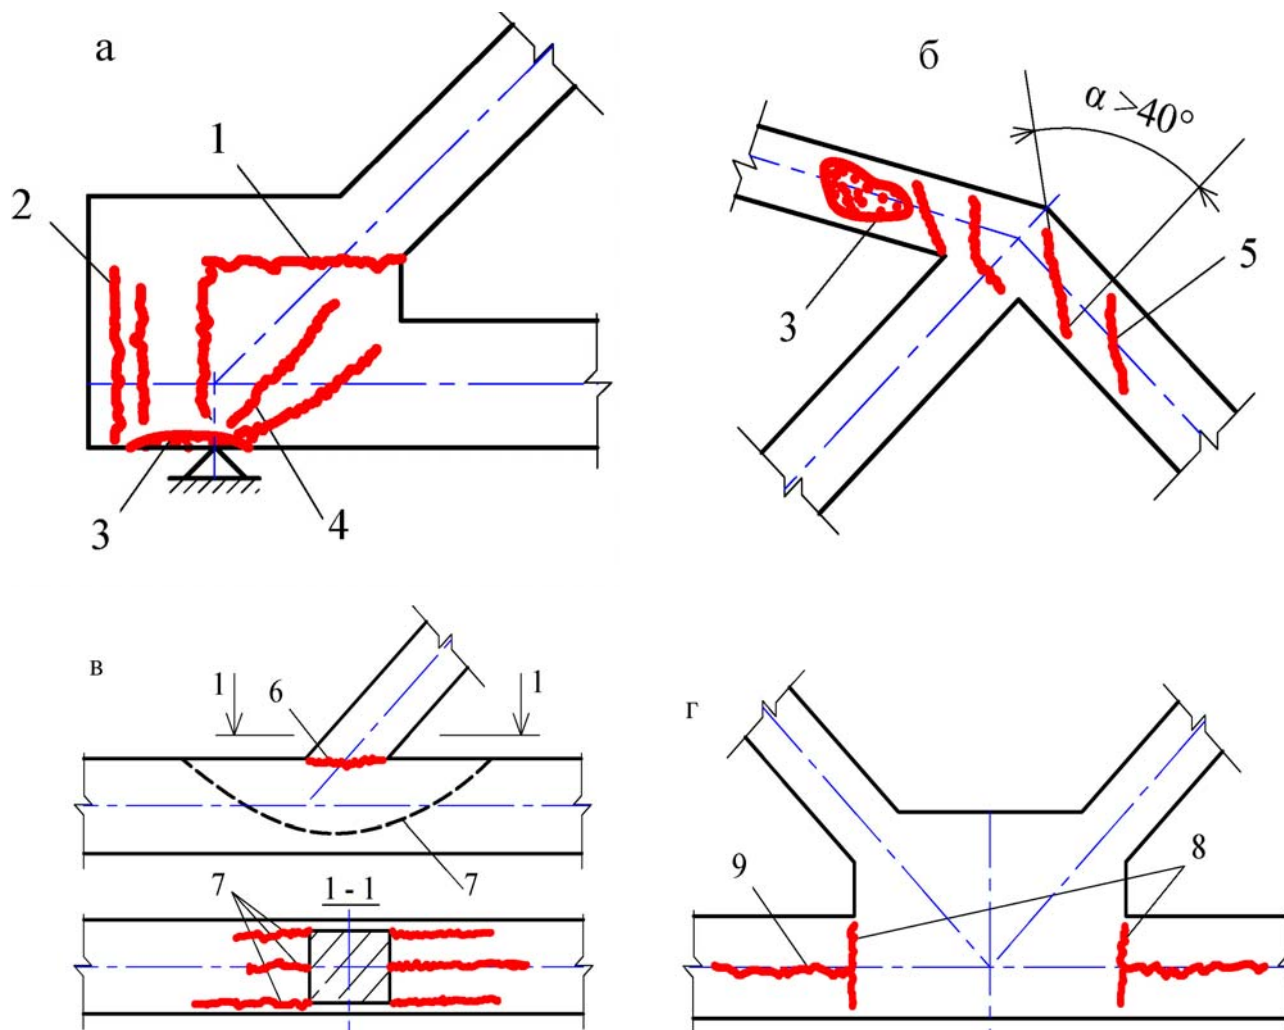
Трещины в элементах железобетонных ферм образованные в следствии коррозии арматуры: а – горизонтальные, вертикальные и наклонные трещины в опорном узле фермы; б – вертикальные трещины и лещадка в сжатом узле пояса фермы; в – трещины по нижнему поясу в узле сопряжения с растянутым раскосом; г – трещины в растянутом поясе и узле фермы.
